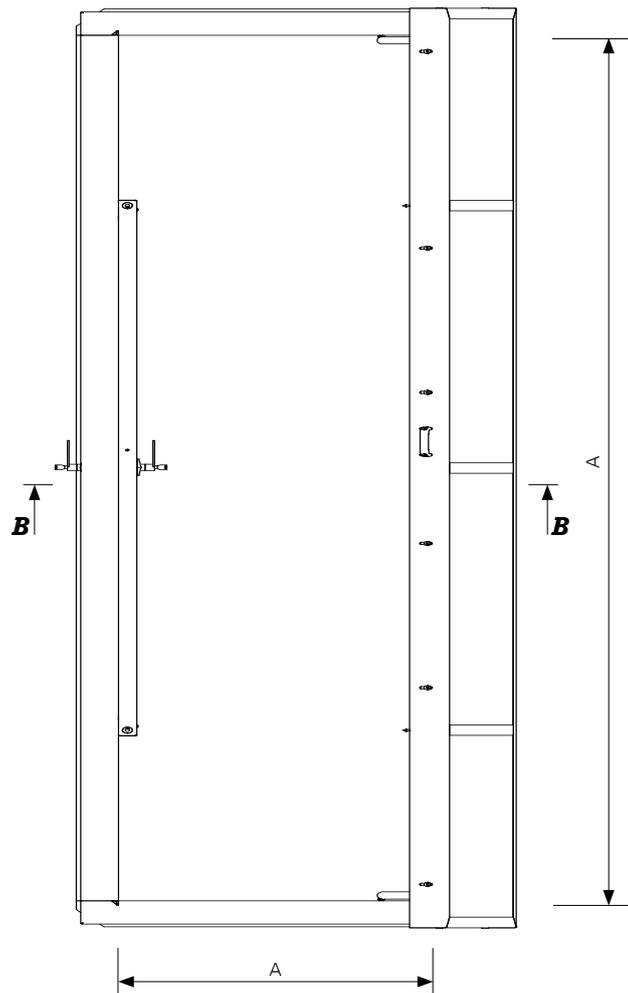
Draufsicht von einem Flachdachausstieg PROROF ST zur Montage über Treppe, in geöffneter Position, Maße in [mm]
